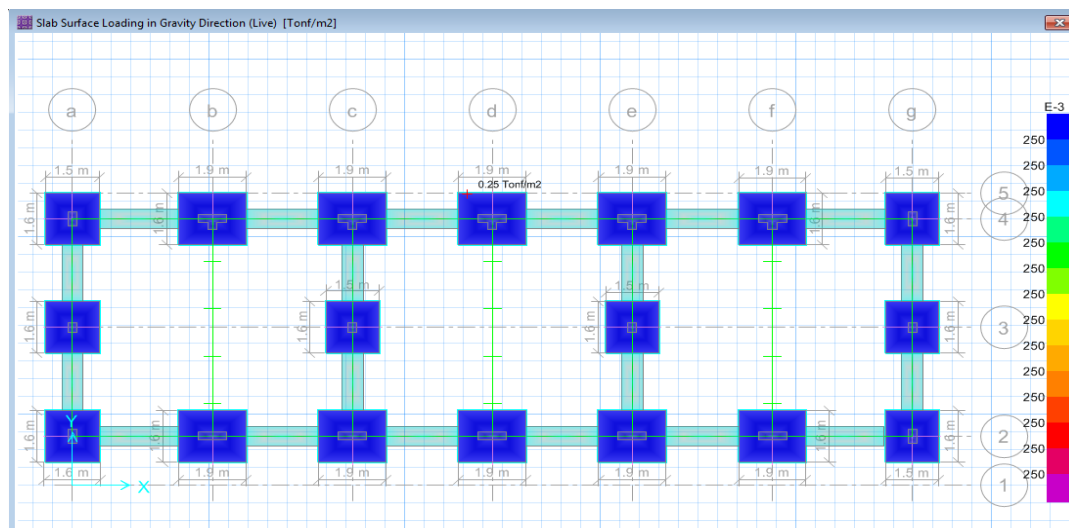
Cargas relleno cimentación de Módulo II y V
